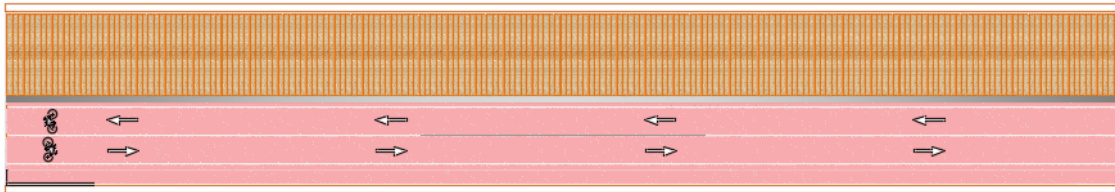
Planta solución desarrollada (Fuente Elaboración propia)
